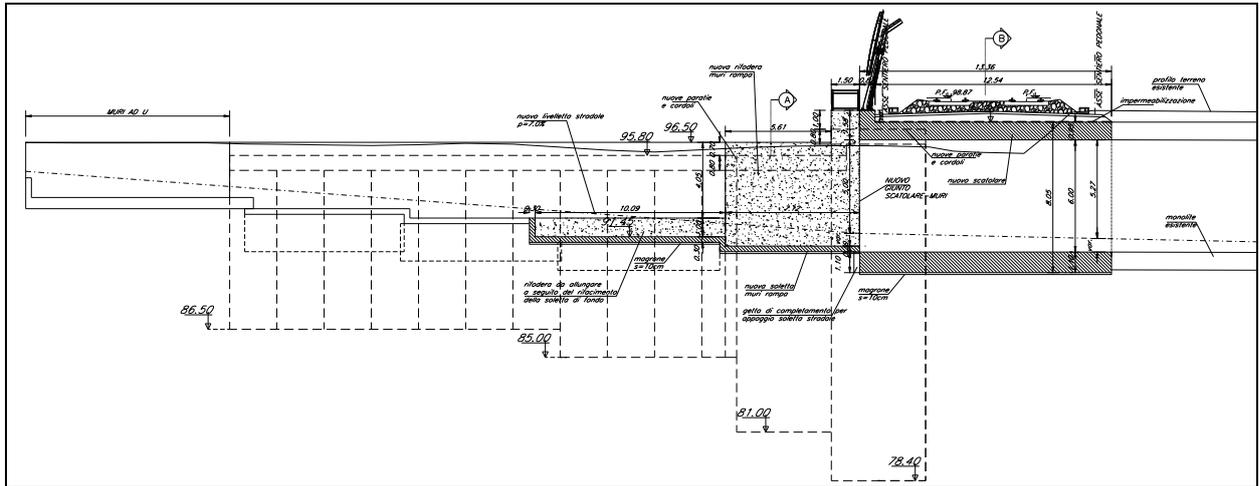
Sezione longitudinale dello scatolare e della rampa.
